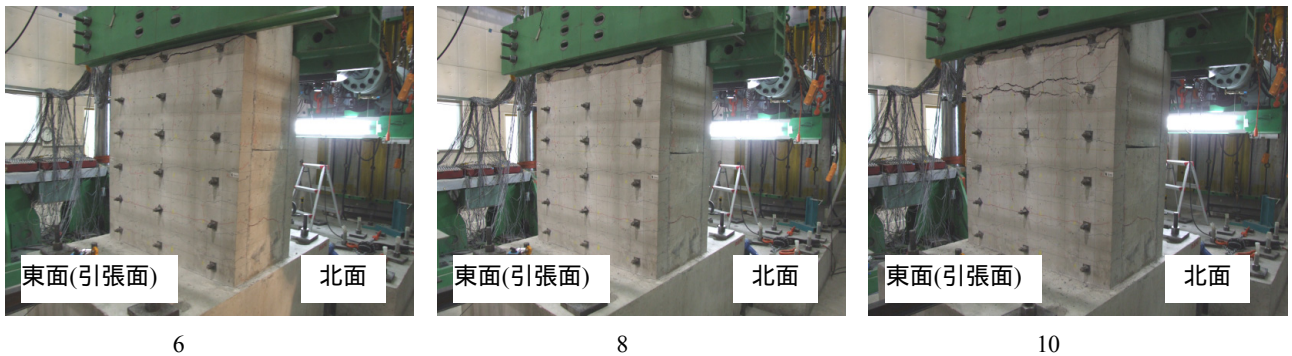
引張面のひび割れ発生状況 (RC-S-11)
